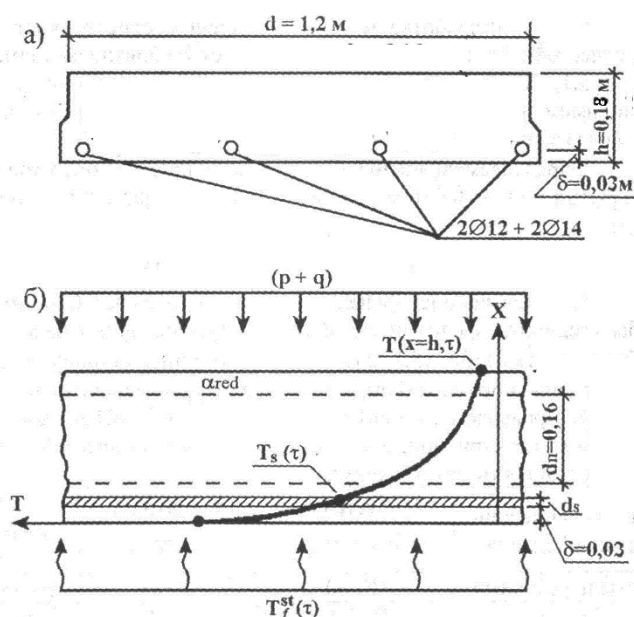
К расчету предела огнестойкости железобетонной, многопустотной плиты перекрытия а) поперечное сечение плиты; б) расчетная схема определения предела огнестойкости плиты.
